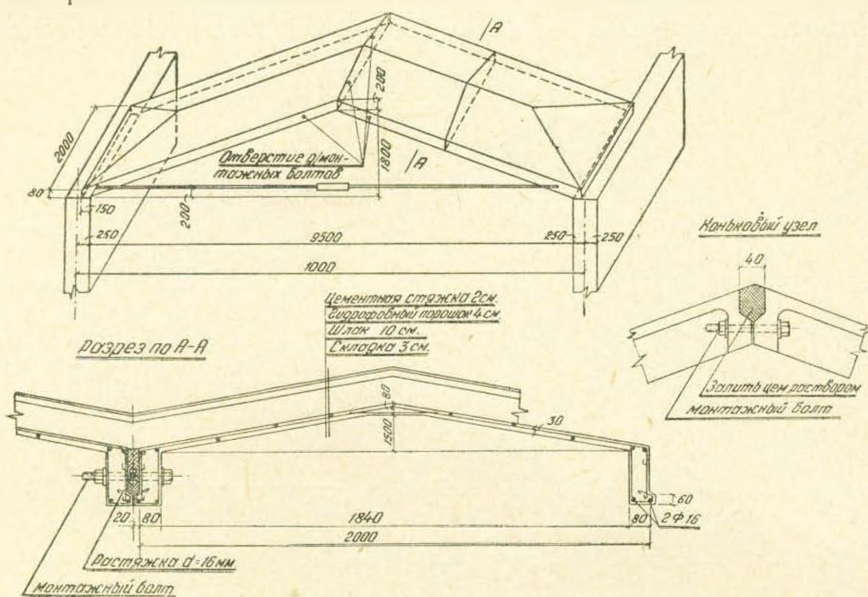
Сборное складчатое железобетонное покрытие с затяжкой.
